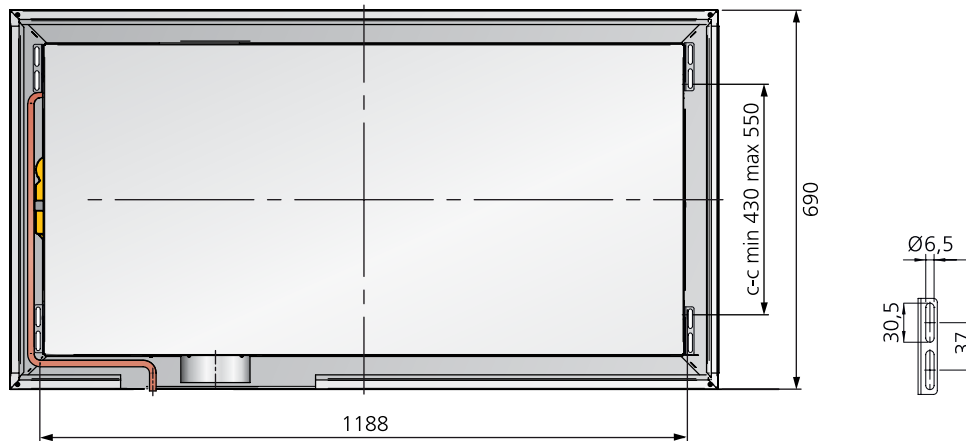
ADAPT Parasol EX 1290, Draufsicht
